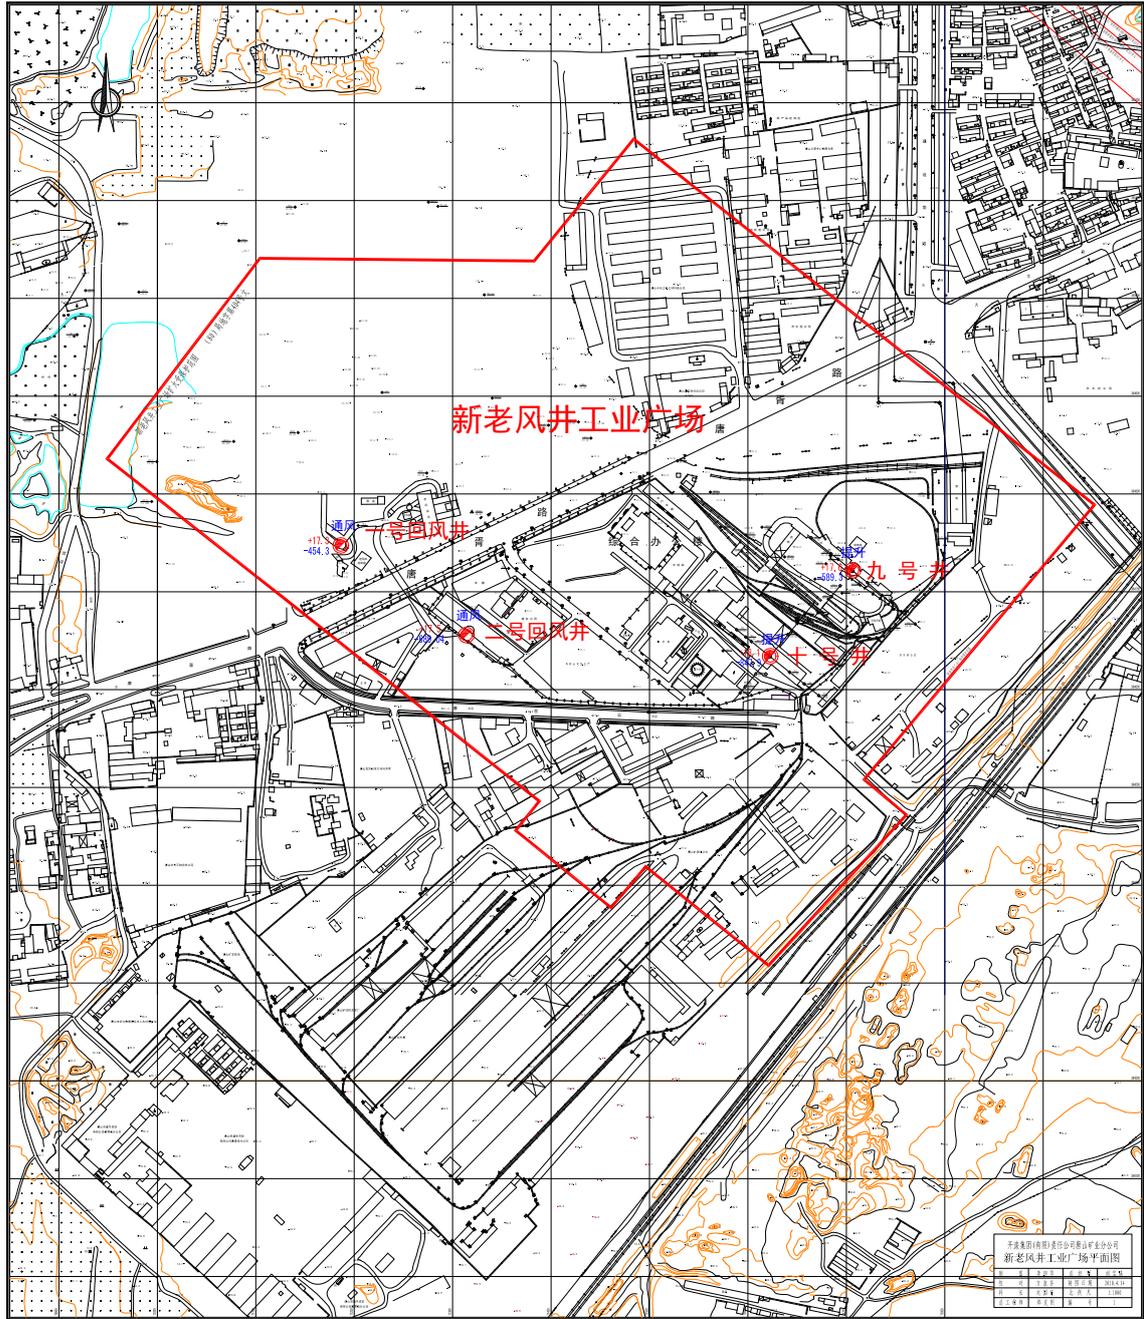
唐山矿新老风井工业广场（B 工业广场）平面布置图
